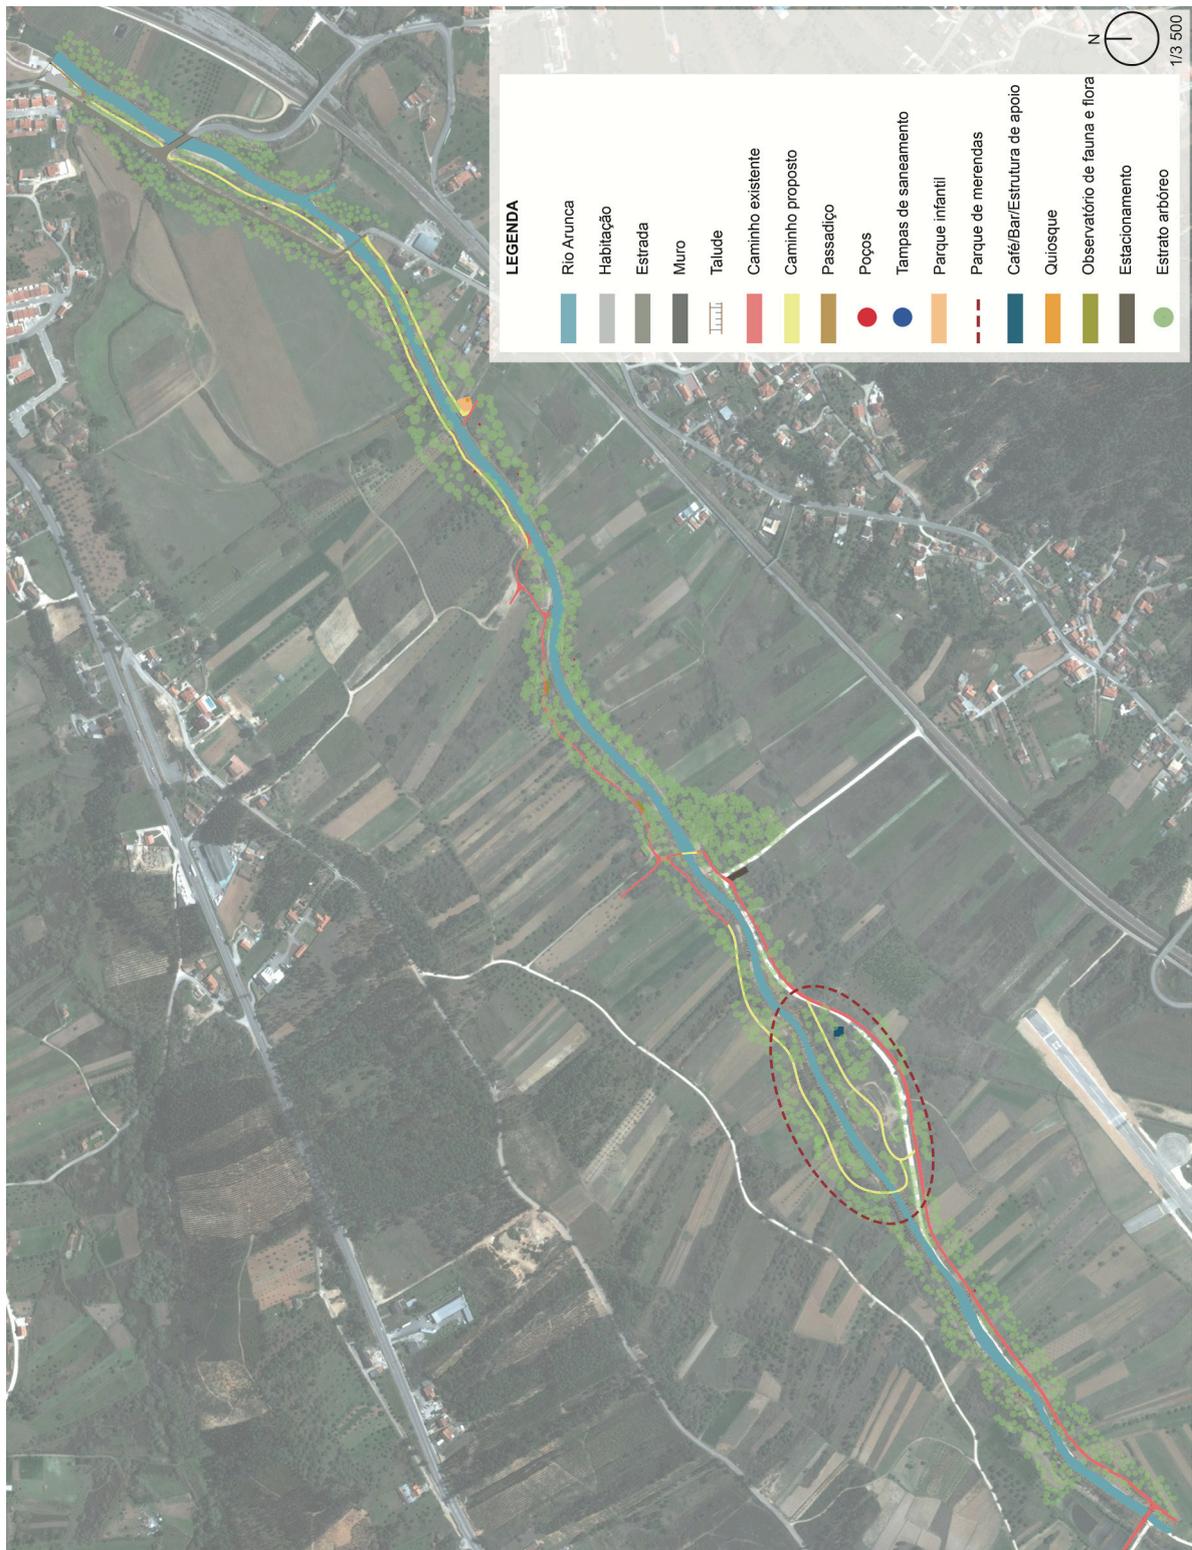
Plano geral da proposta (Fonte: Autor, 2016) (Anexo 7).
